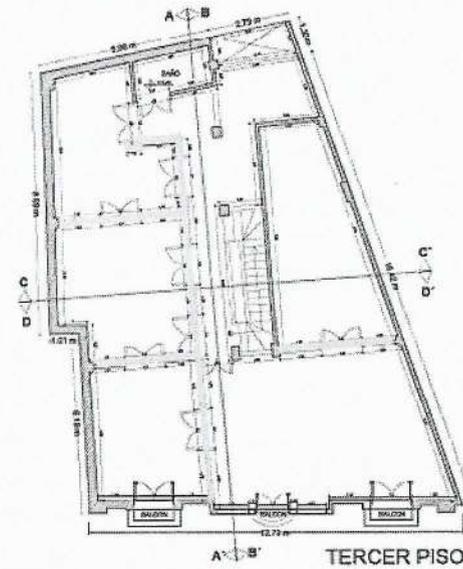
Plano de levantamiento (muros propuestos a demoler)
